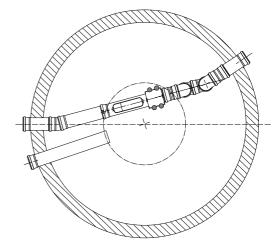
Beispielhafter Einbau eines PR100. Installation in einem Betonspeicher
